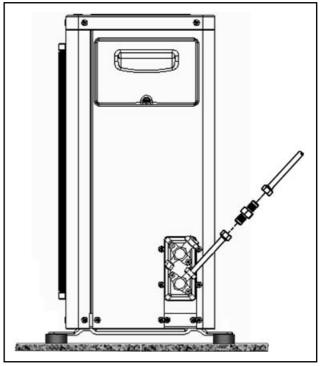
INSTALAÇÃO KIT SISTEMA DE EXPANSÃO
